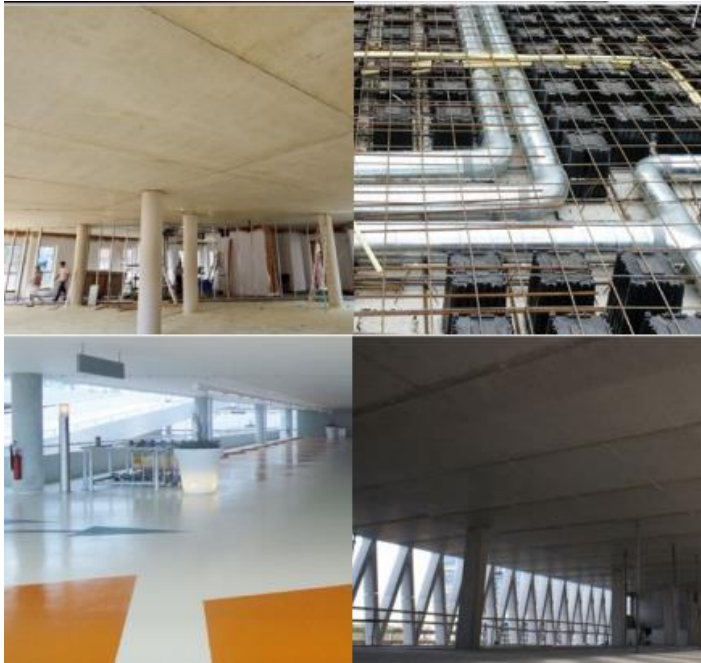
l'installation de canalisation par rapport de plancher allégés.
